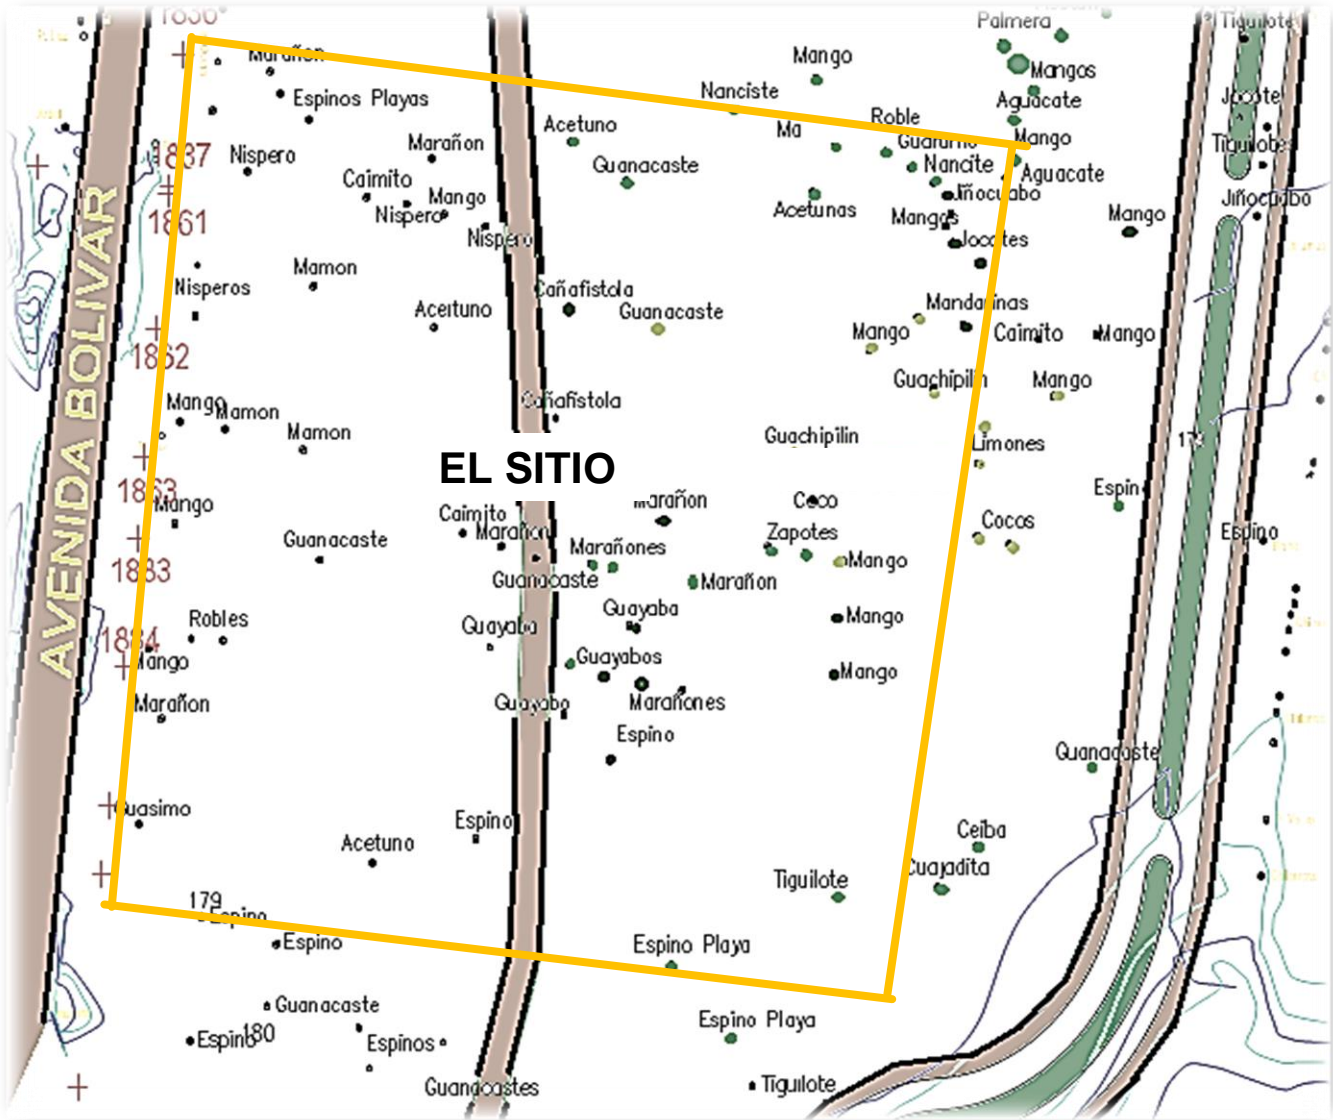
Levantamiento de Vegetación (UNAN, 2014)
